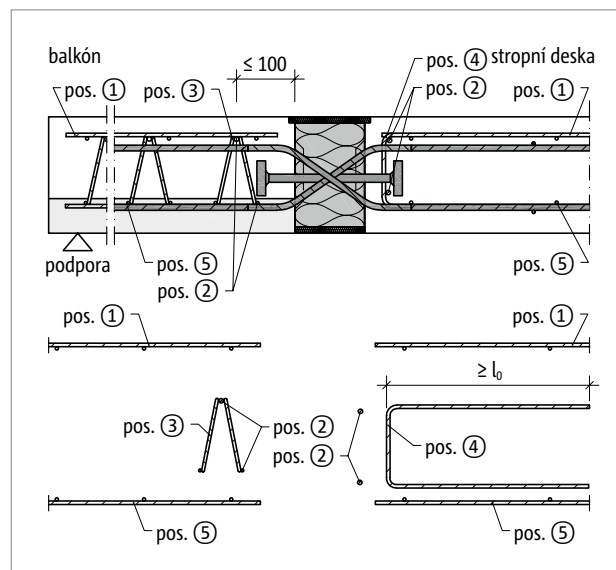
Schöck Isokorb® XT typ QP: Napojovací stavební výztuž
